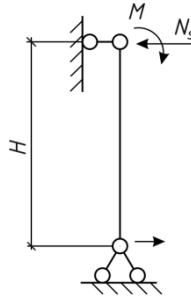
Определение усилия в анкере от изгибающего момента в уровне перекрытия
